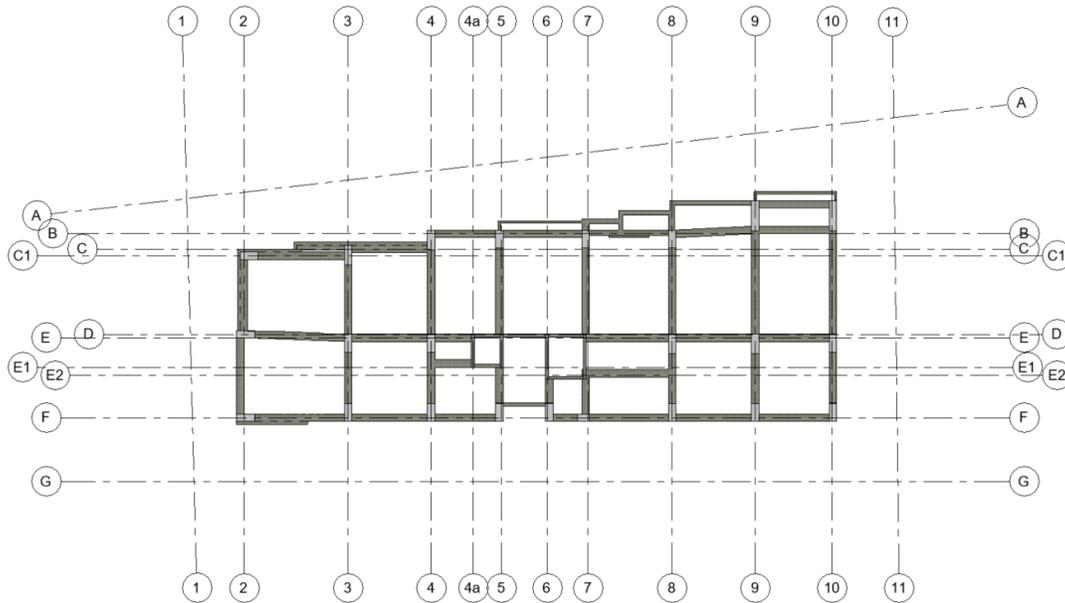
Modelado de vigas, vista en planta, piso 1.
